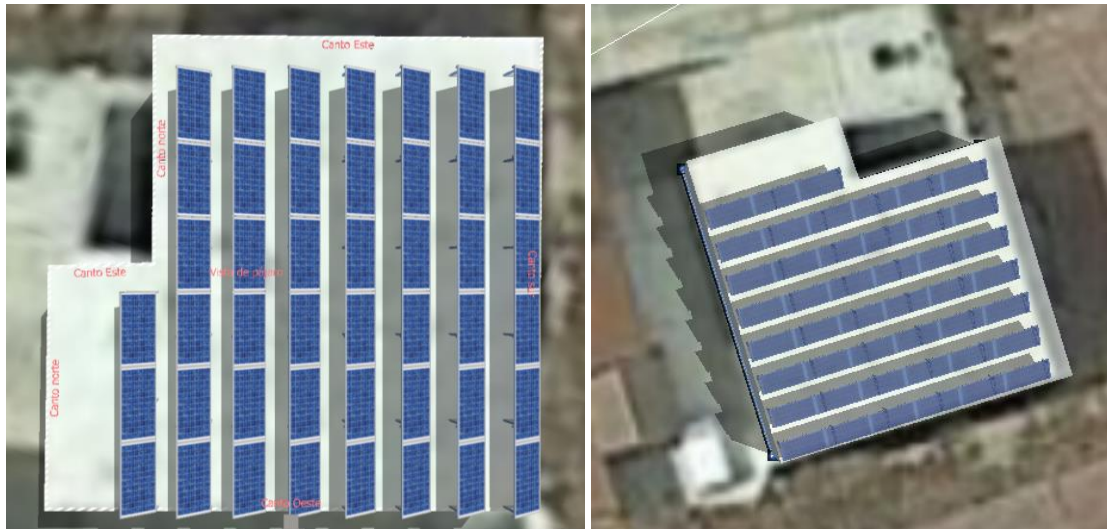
Distribución en planta de placas fotovoltaicas en la cubierta
